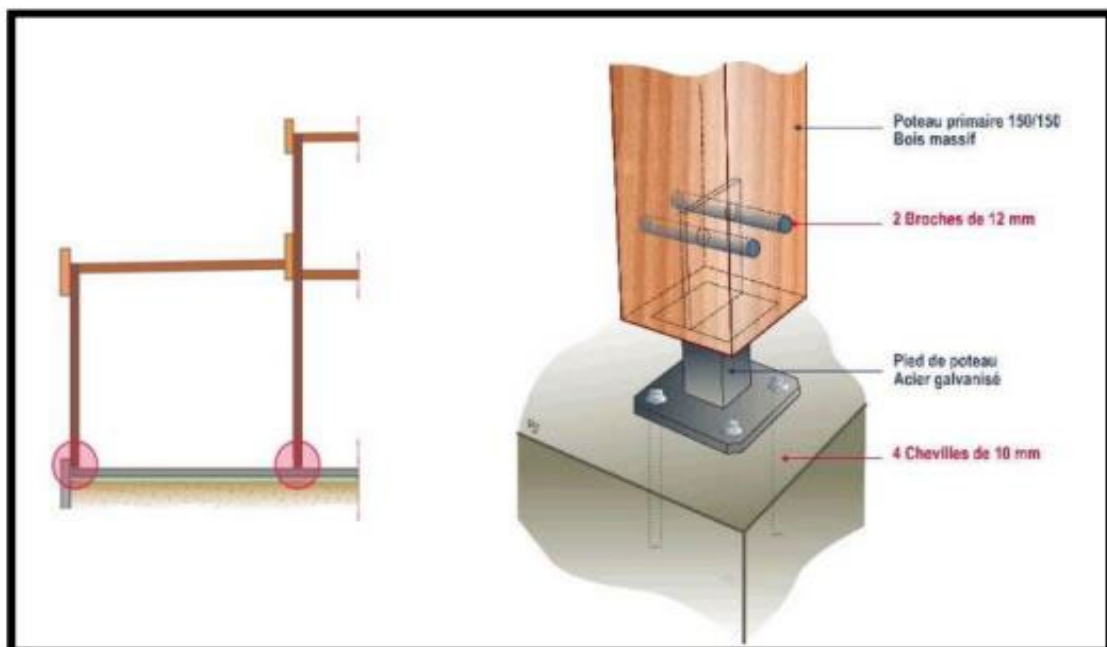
Détail liaison poteau soubassement en pierre (construction en bois)
